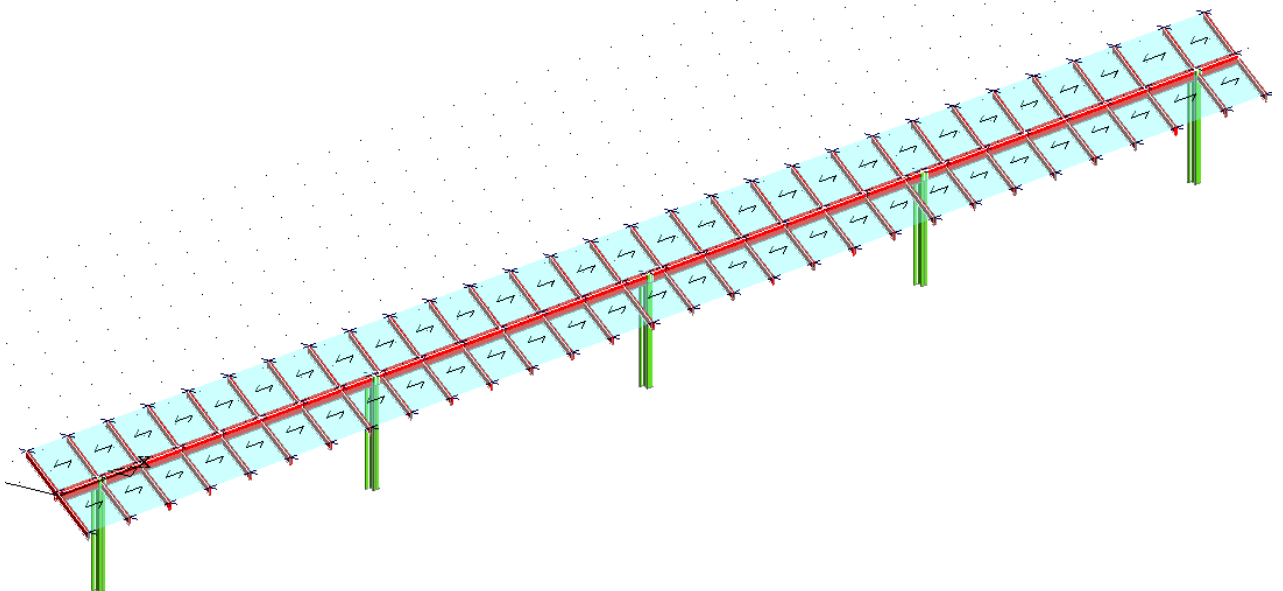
Vista assonometrica modello strutturale con posizione della "vela" inclinata di 60°
